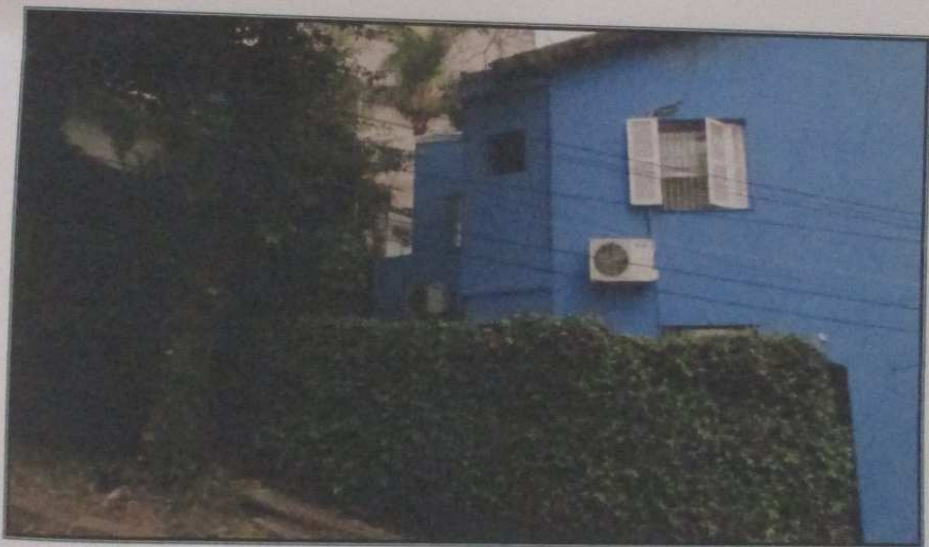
Fachada lateral do imóvel junto aos fundos do terreno.
